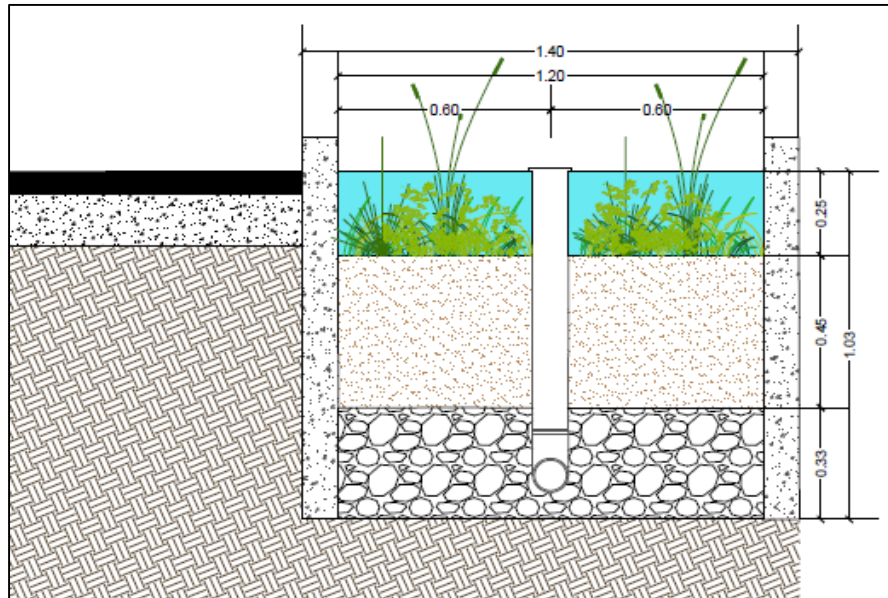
Corte sección transversal en zona de bioretención de 1.20 x 2.20 m
